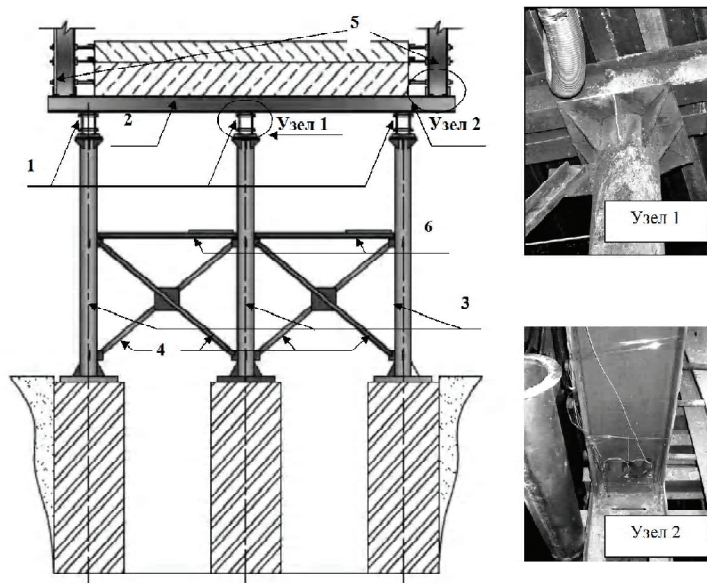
Конструктивная схема дна стекловаренной печи (поперечный разрез): 1 – продольные балки; 2 – поперечные балки; 3 – колонны дна; 4 – поперечные связи; 5 – колонны каркаса обвязки печи; 6 – площадки для обслуживания.
